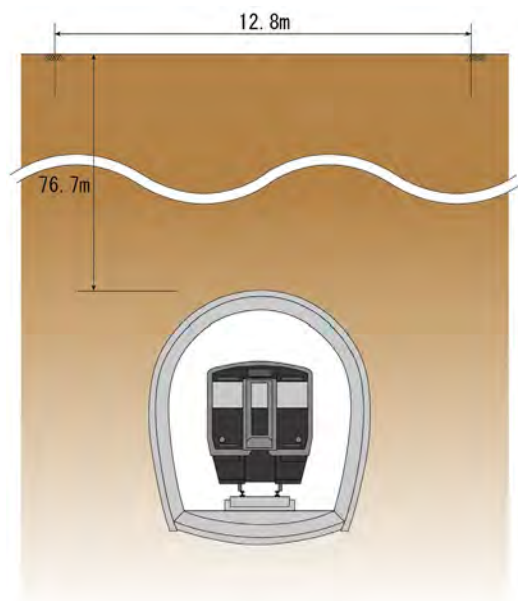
(4) 計画路線の標準横断面図 (断面④：地下式)
